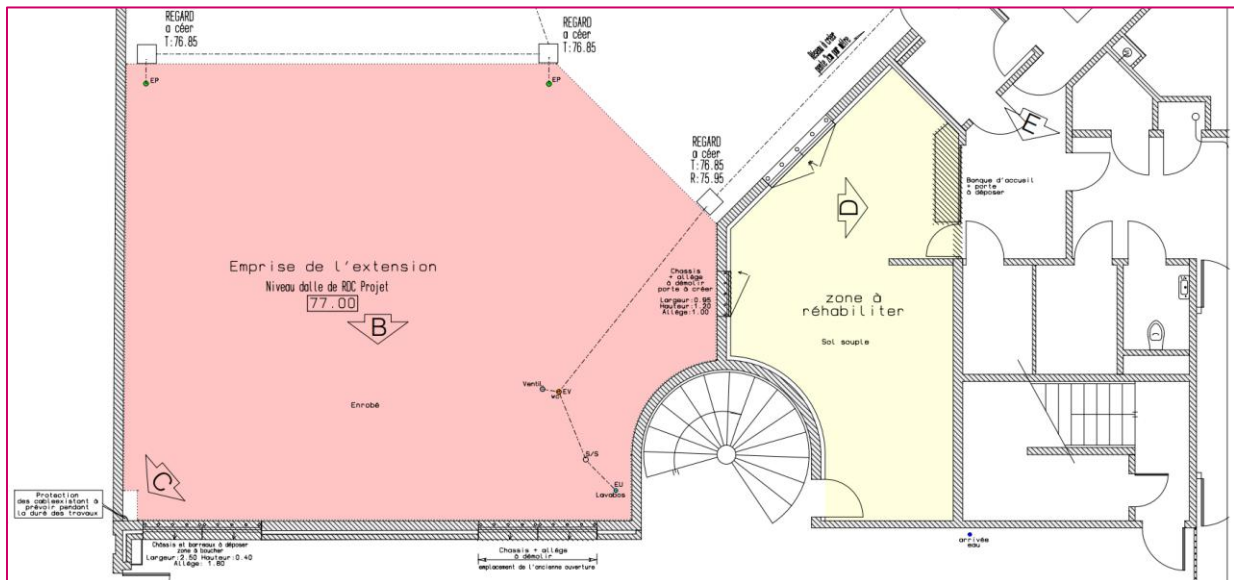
Emprise de l'extension sans échelle, (Plan projet, B.A.U. Architectes)
